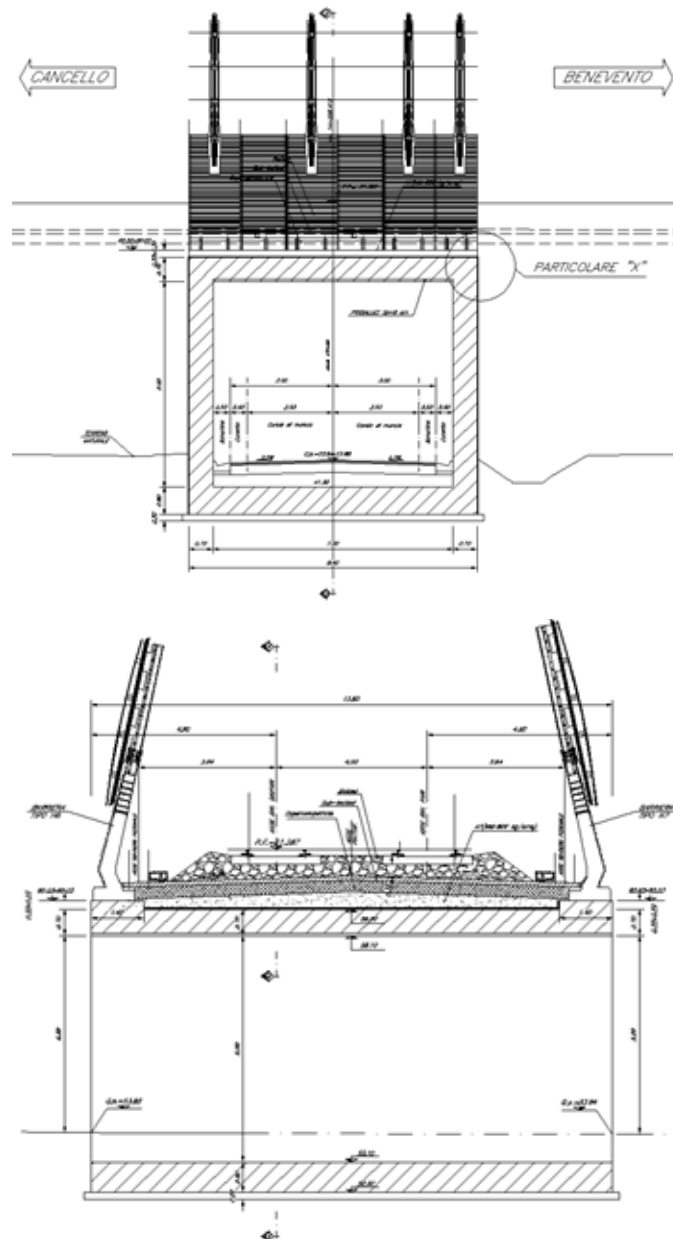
Sezione trasversale e sezione longitudinale del manufatto
